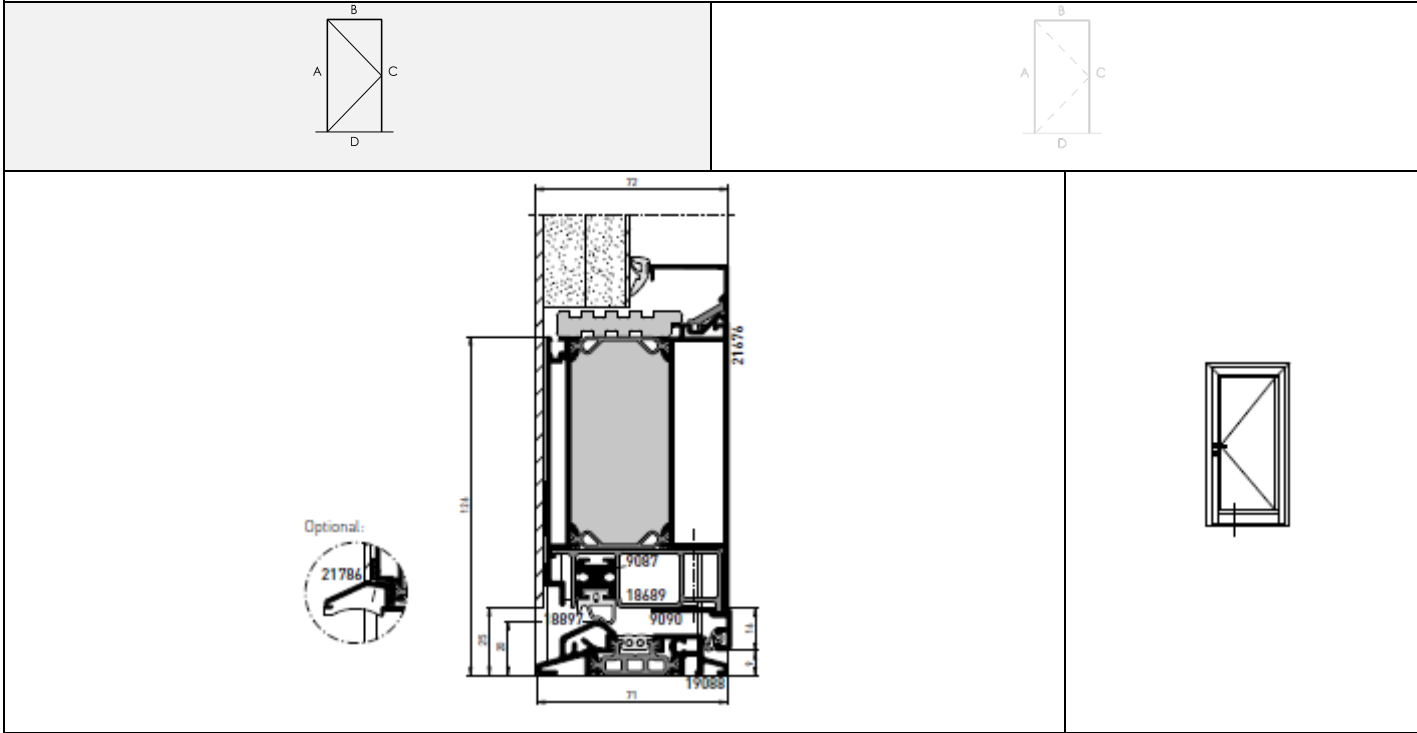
Coupe type porte avec panneau ouvrant vers l'intérieur
